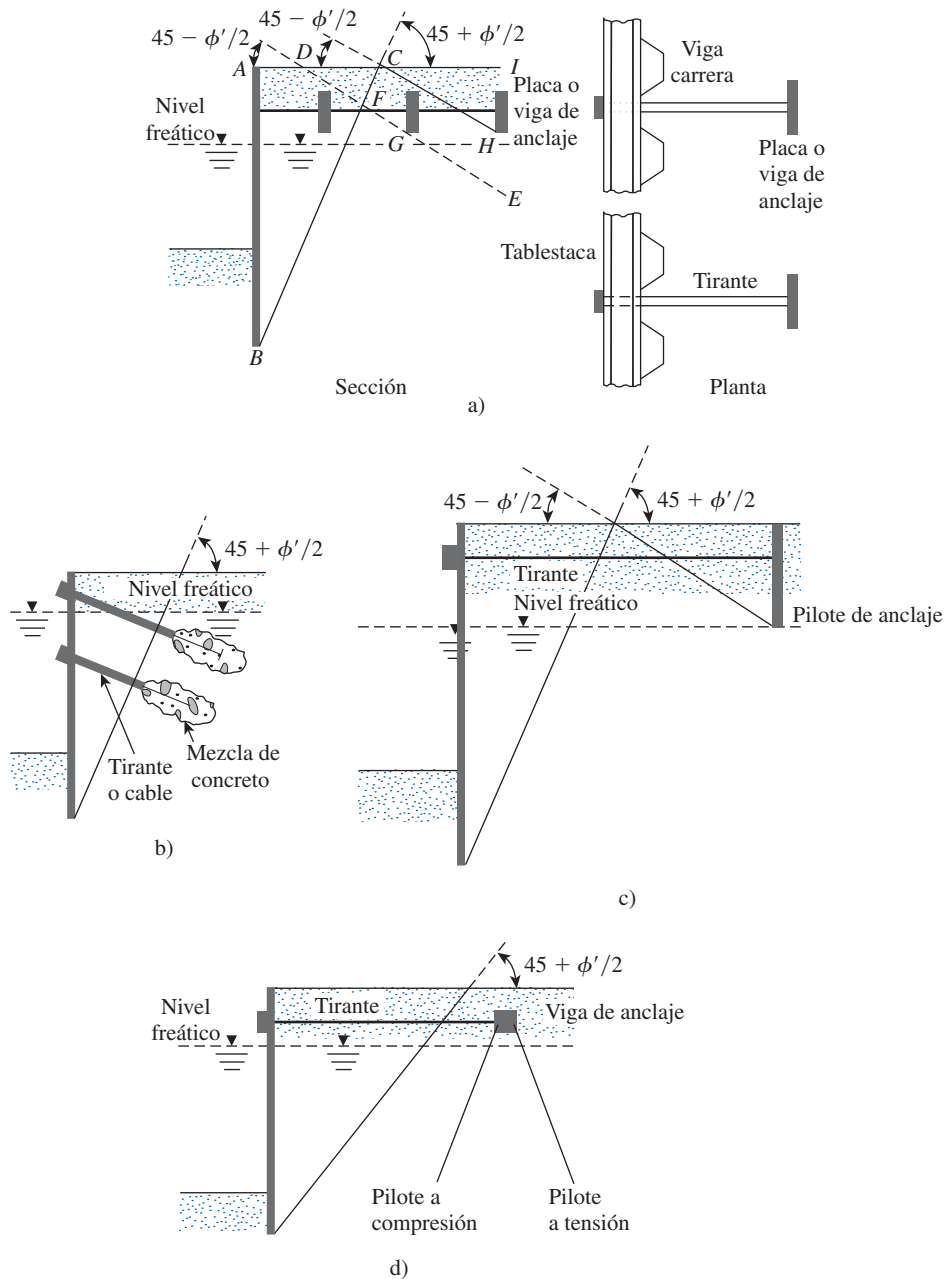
Varios tipos de anclajes para muros de tablestacas: a) placa o viga de anclaje; b) tirante; c) pilote vertical de anclaje; d) viga de anclaje con pilotes inclinados.
